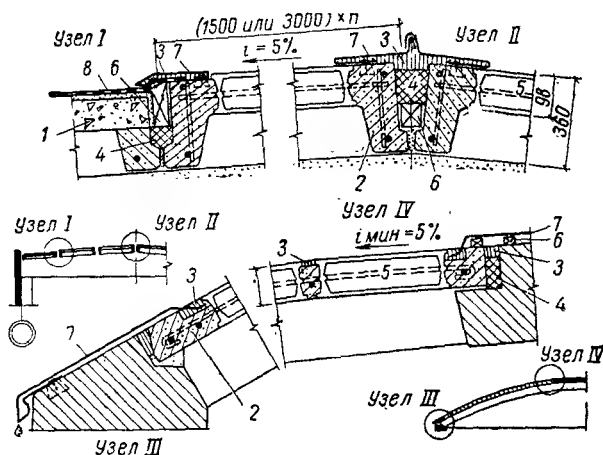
Стекложелезобетонные покрытия по балкам (фермам) и в сводчатом покрытии
